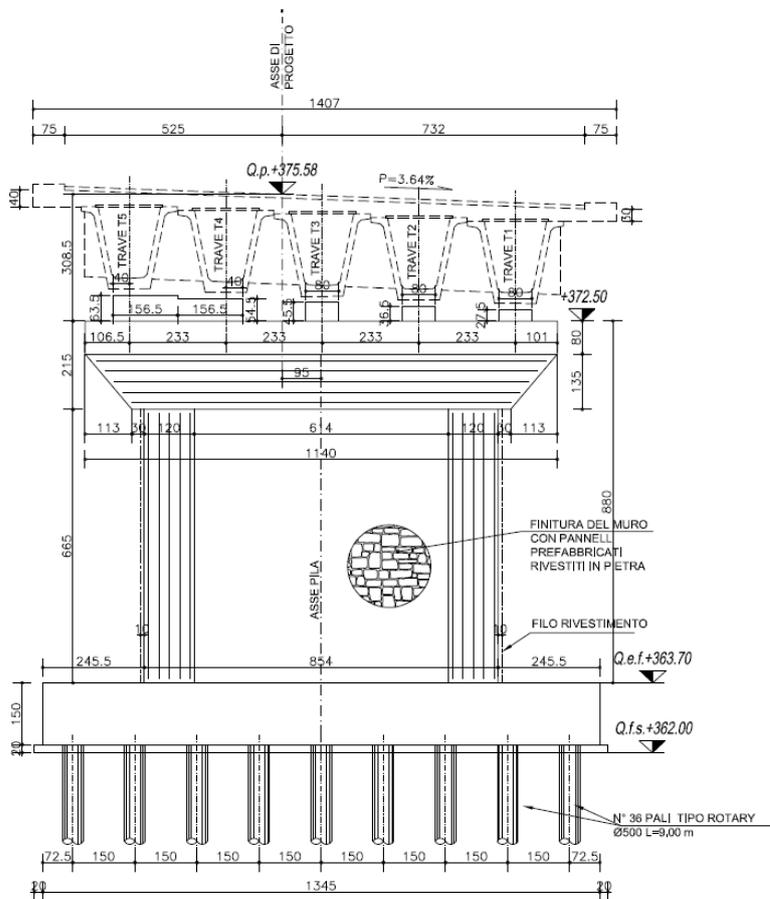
SEZIONE TRASVERSALE PILA VIADOTTO CASAL DEL MONTE
